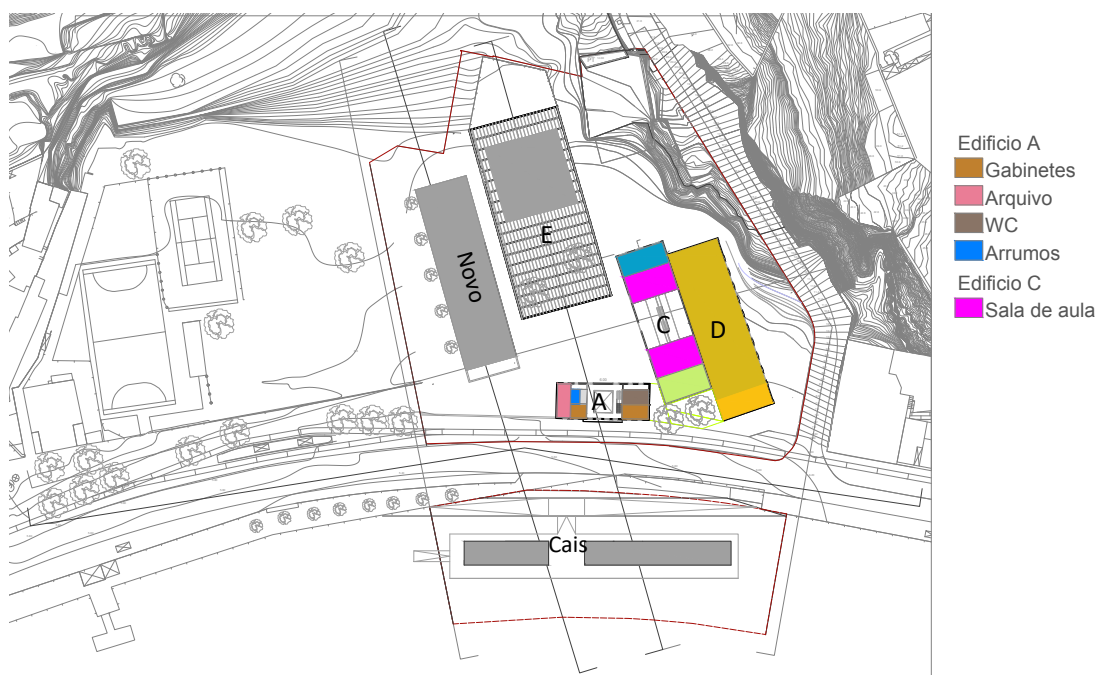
Planta piso 1 – 5ª proposta – com indicação dos espaços (fonte: autora)
